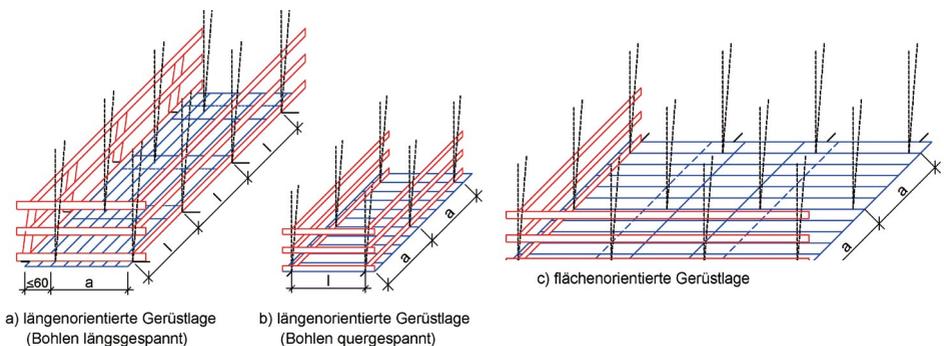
Regelausführung der Hängegerüste mit Rundholzstangen nach DIN 4420-3
